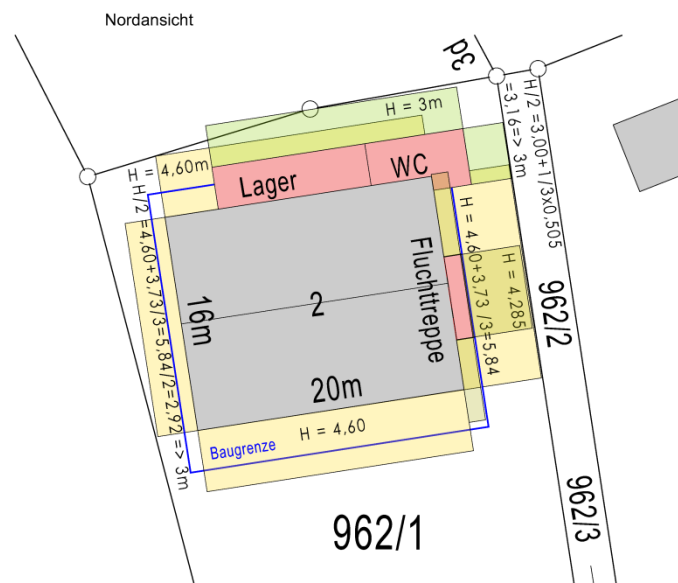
Geplante Anbauten an das Bestandsgebäude Pfarrstadel mit Darstellung der Abstandsflächen, Böck Architekten 2016, unmaßstäbliche Darstellung
